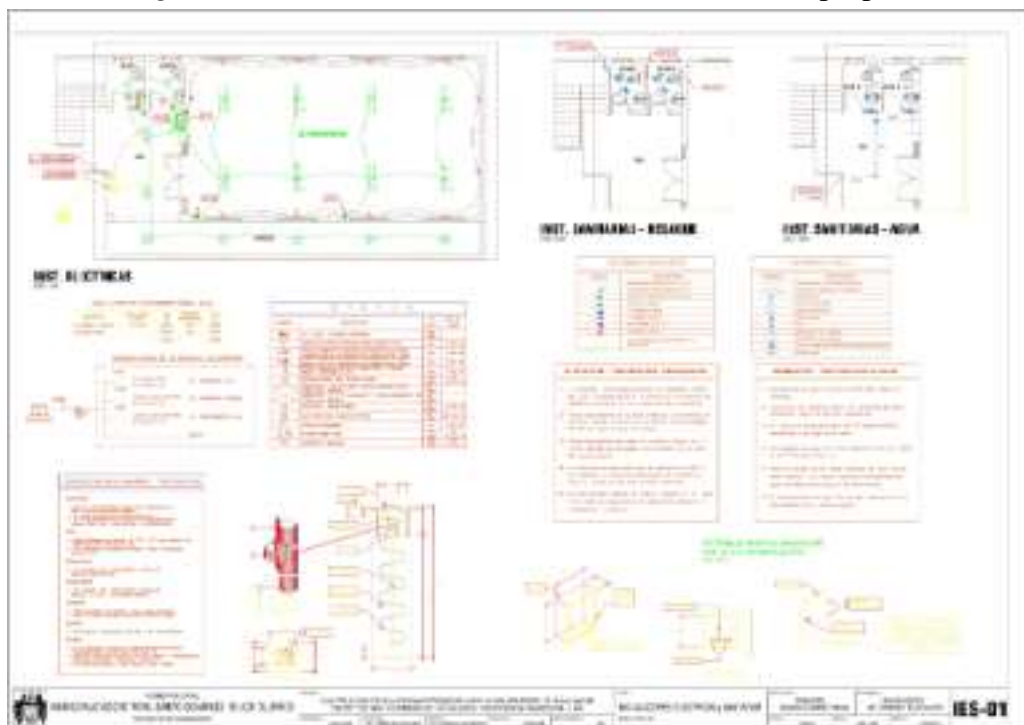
Plano de Instalaciones Eléctricas y Sanitarias (Fuente: Elaboración propia)
